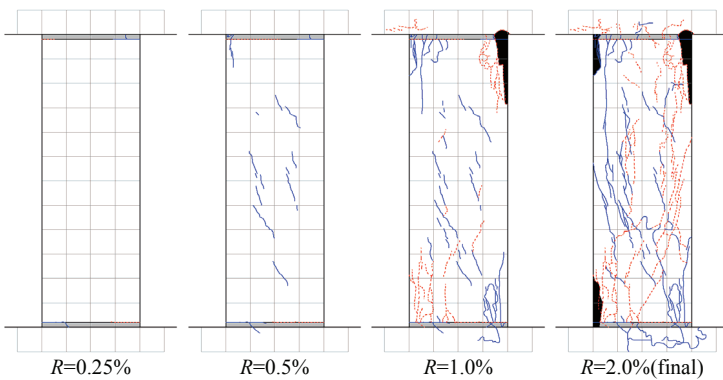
U1/2-0.1t ひび割れ状況
